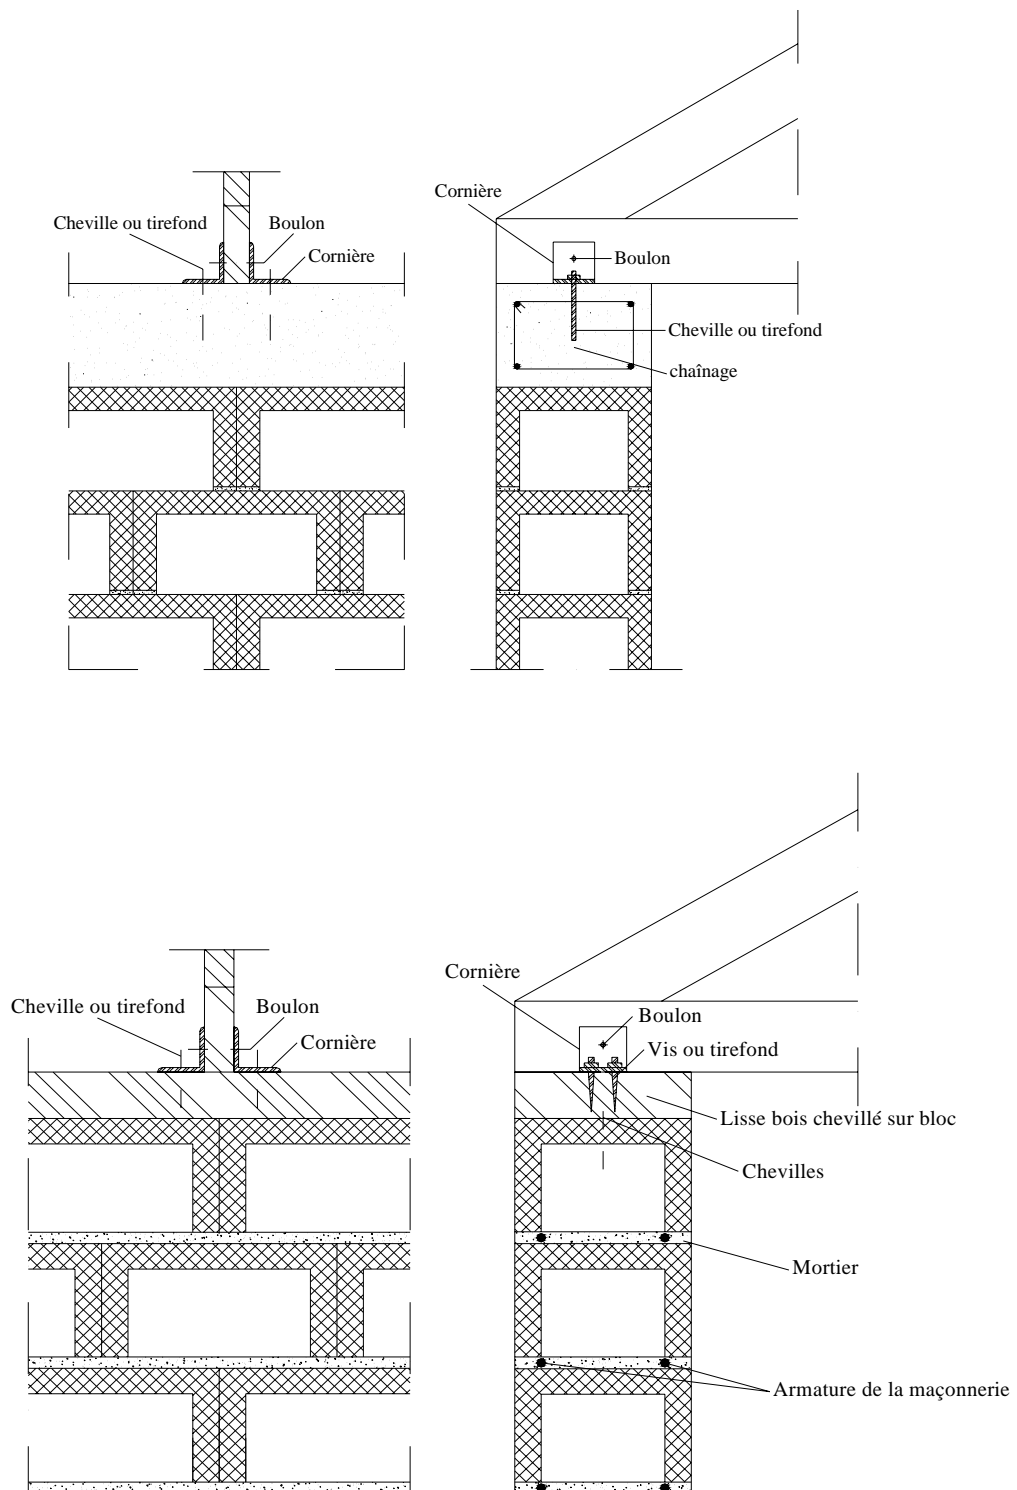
Exemples d'ancrage de ferme (a) sur une poutre de chaînage en béton armé (b) sur une lisse en bois chevillée sur bloc
